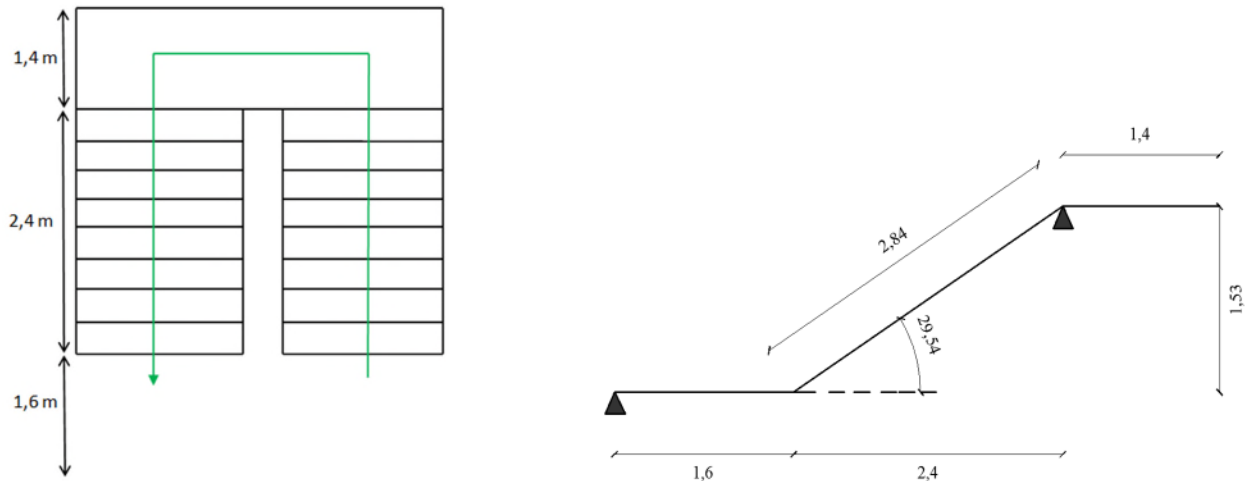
Vue en plan et schéma de l'escalier droits à deux volées.
